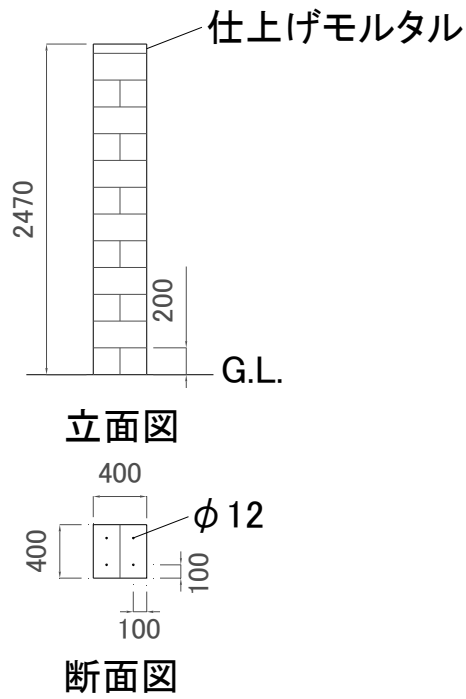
CB 柱の立面図・断面図 (単位 : mm)
